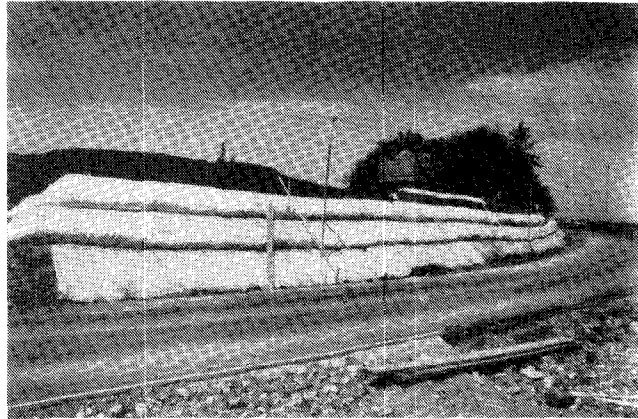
Straßenbau (Lärmschutzwall bei Rapperswil, CH)
